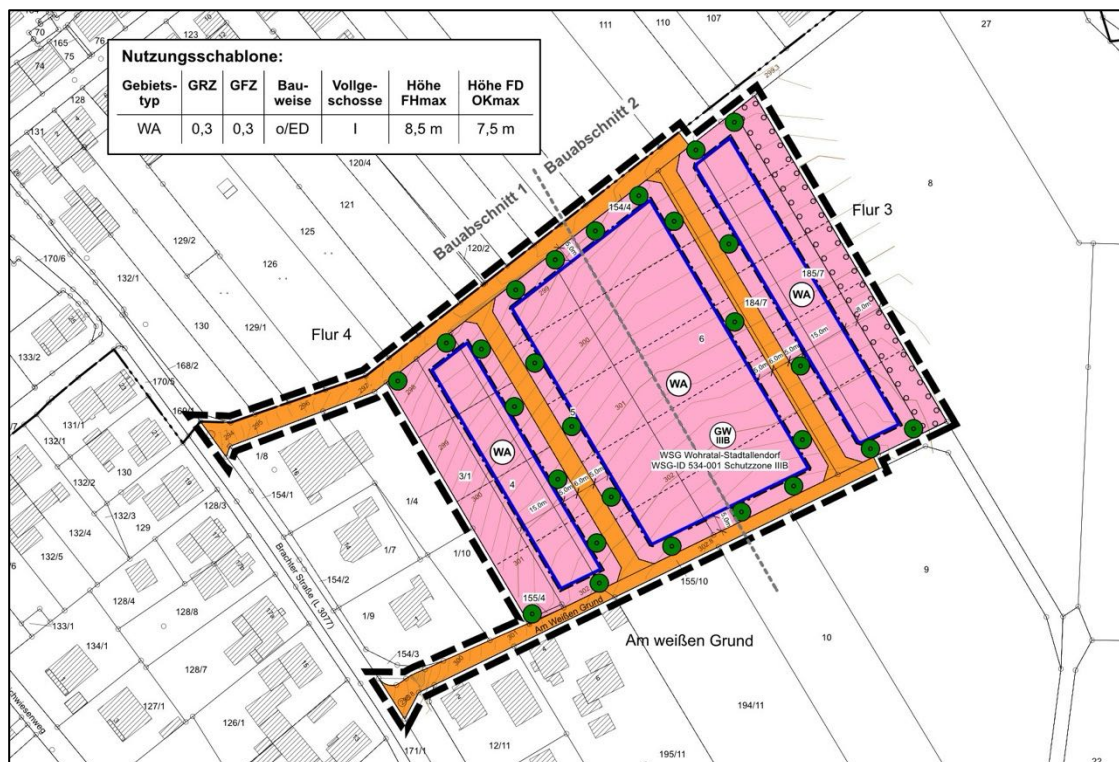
Bebauungsplan – Planteil (unmaßstäblich)
